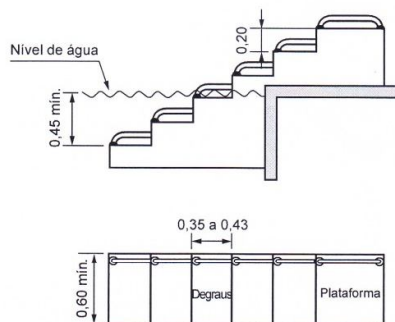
Escada submersa – Exemplo – Vistas lateral e superior
